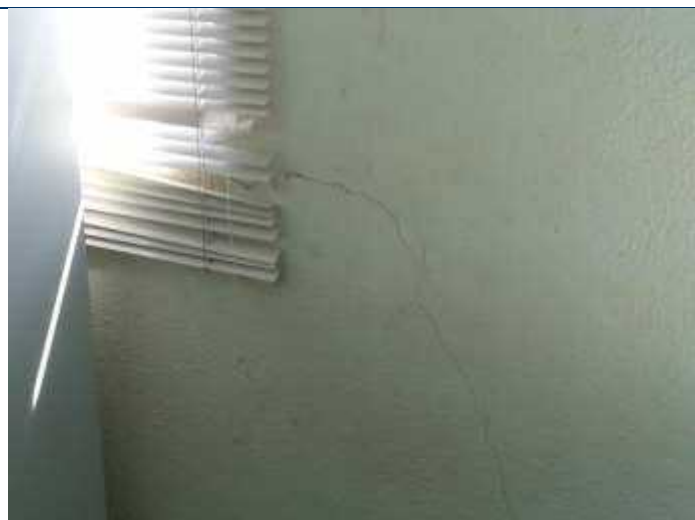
Parede com fissura irregular e manchas de infiltração entre as janelas.
